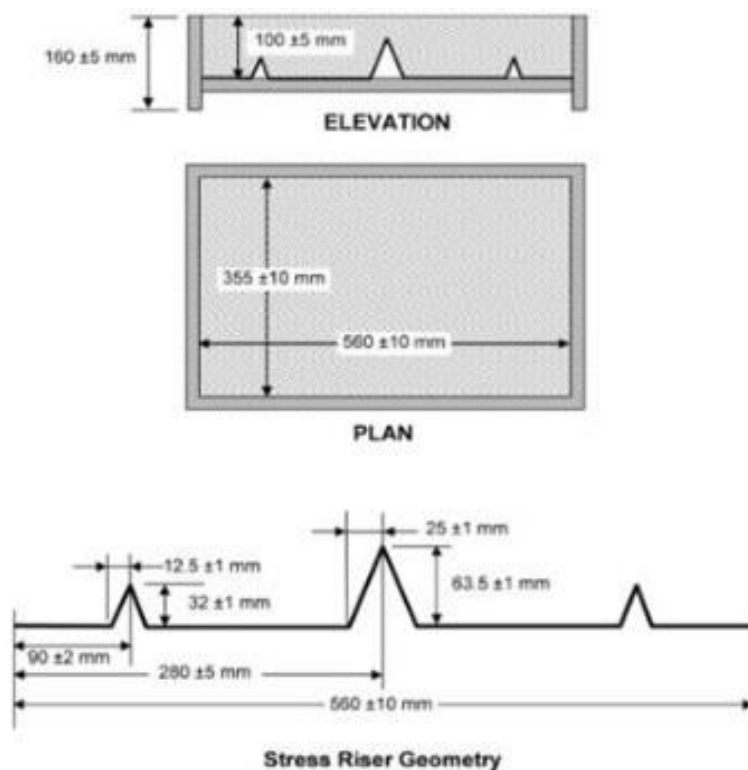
Geometría de losa de confinamiento de inducción de fisuramiento
